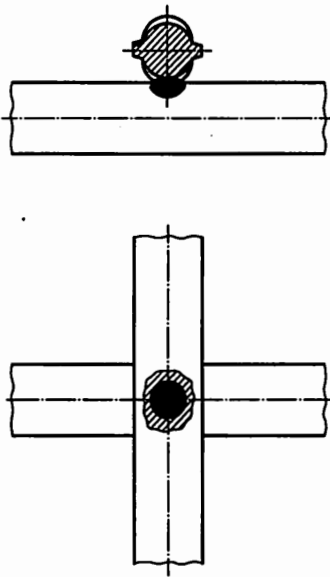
Kreuzungsstoß, Schweißprozesse 21 und 23
